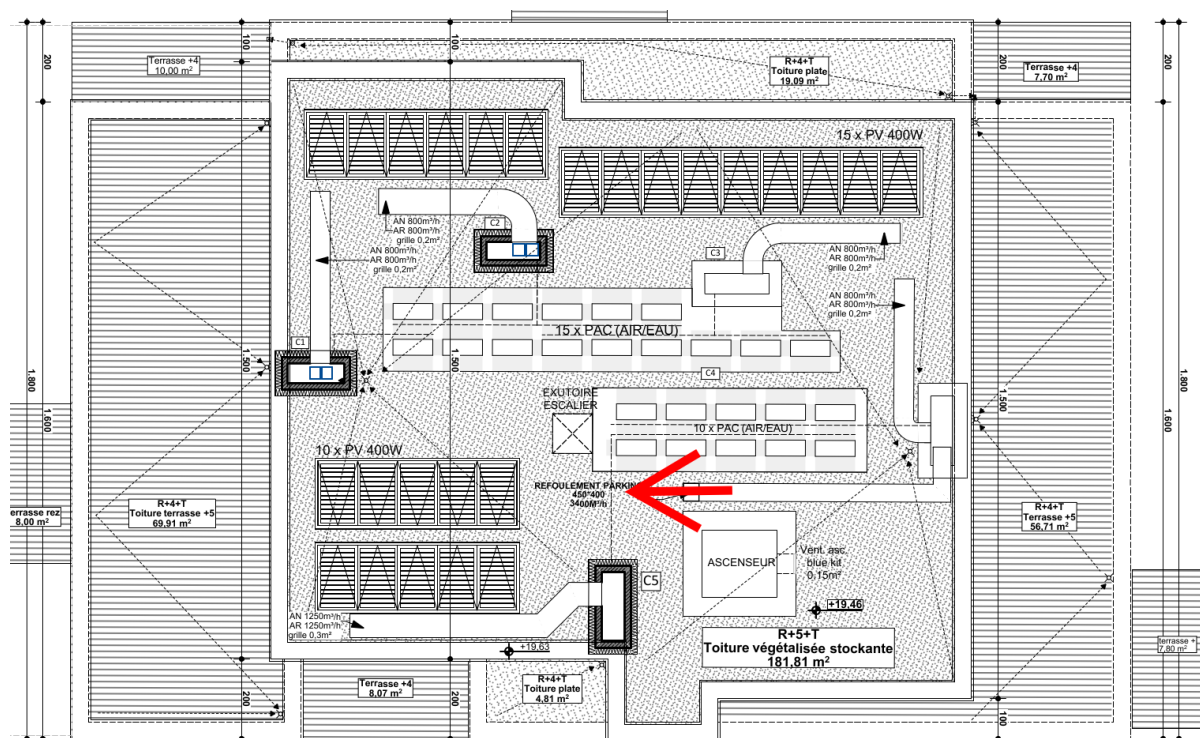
Plan de toiture du bâtiment 2 – rejet air vicié parking en rouge (source : Plans PU)
